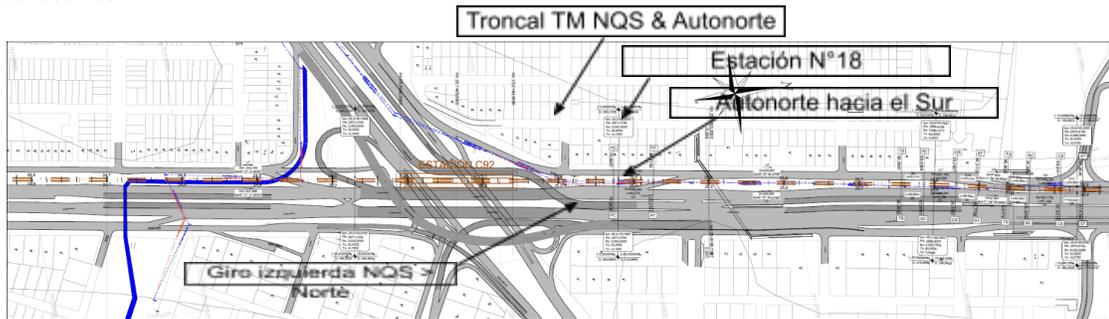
Vista en planta del trazado extensión de la PLMB, Tramo "nodo calle 92"-calle 100 Sur
